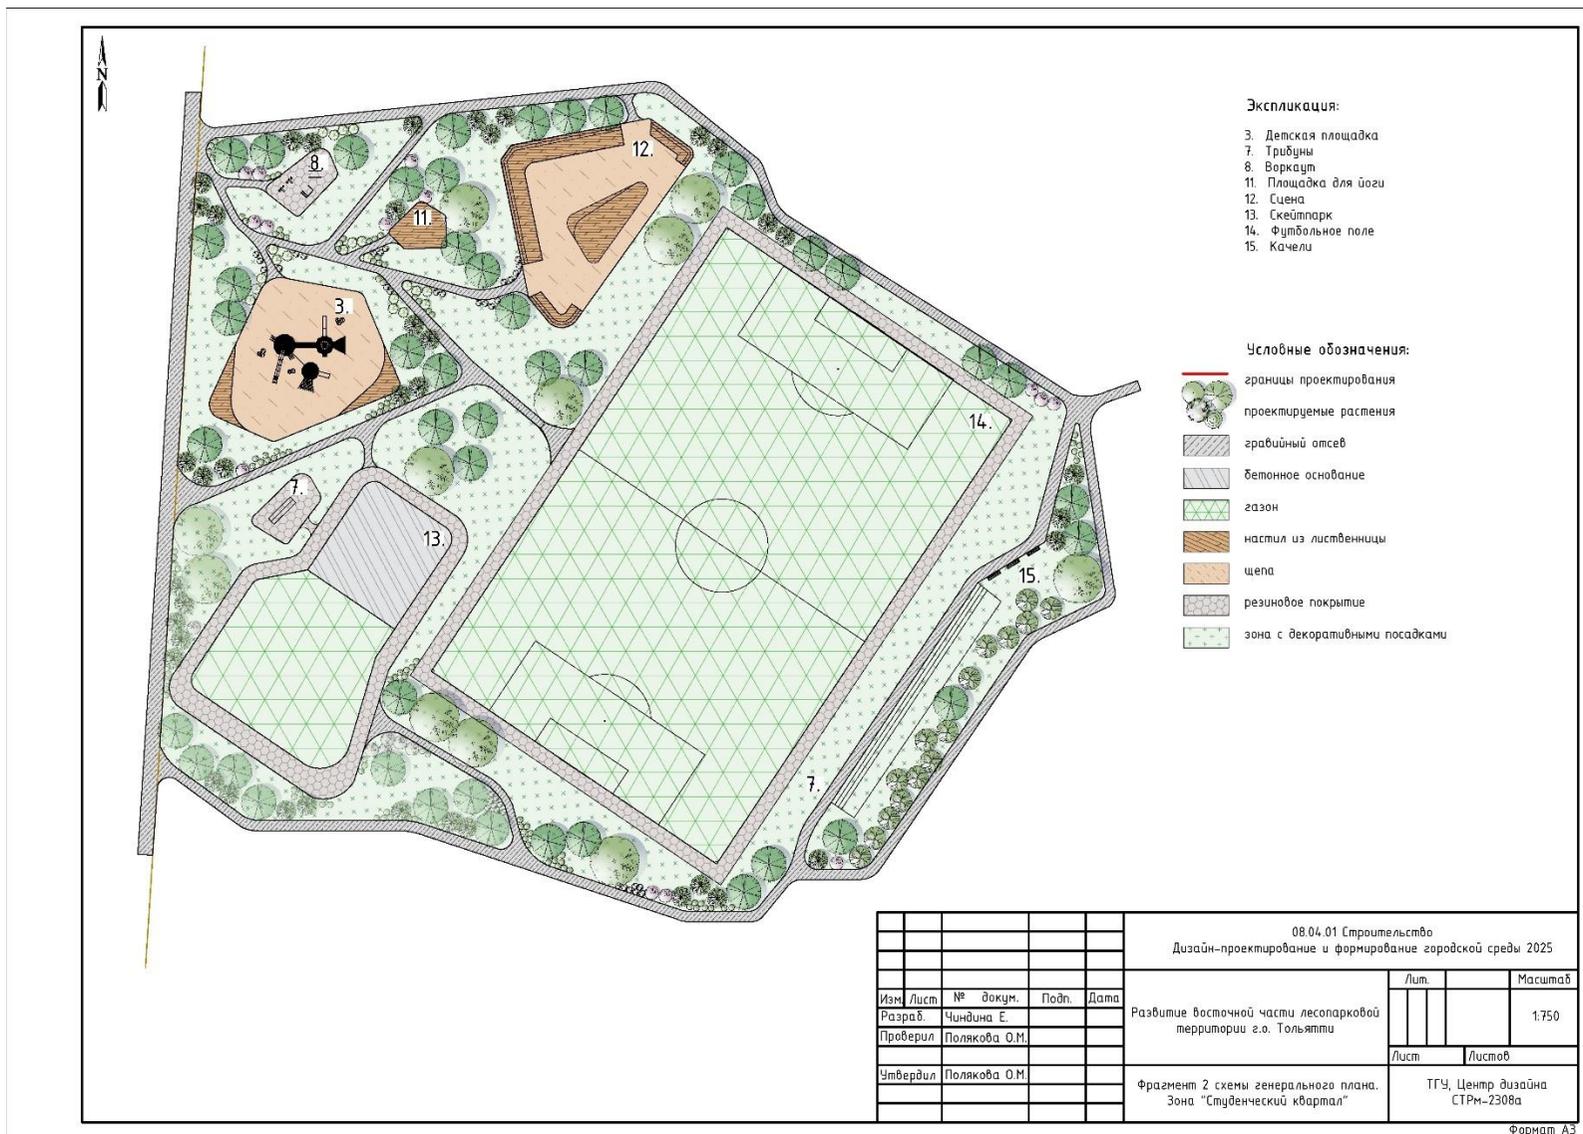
Фрагмент 2 схемы генерального плана. Зона «Студенческий квартал»
